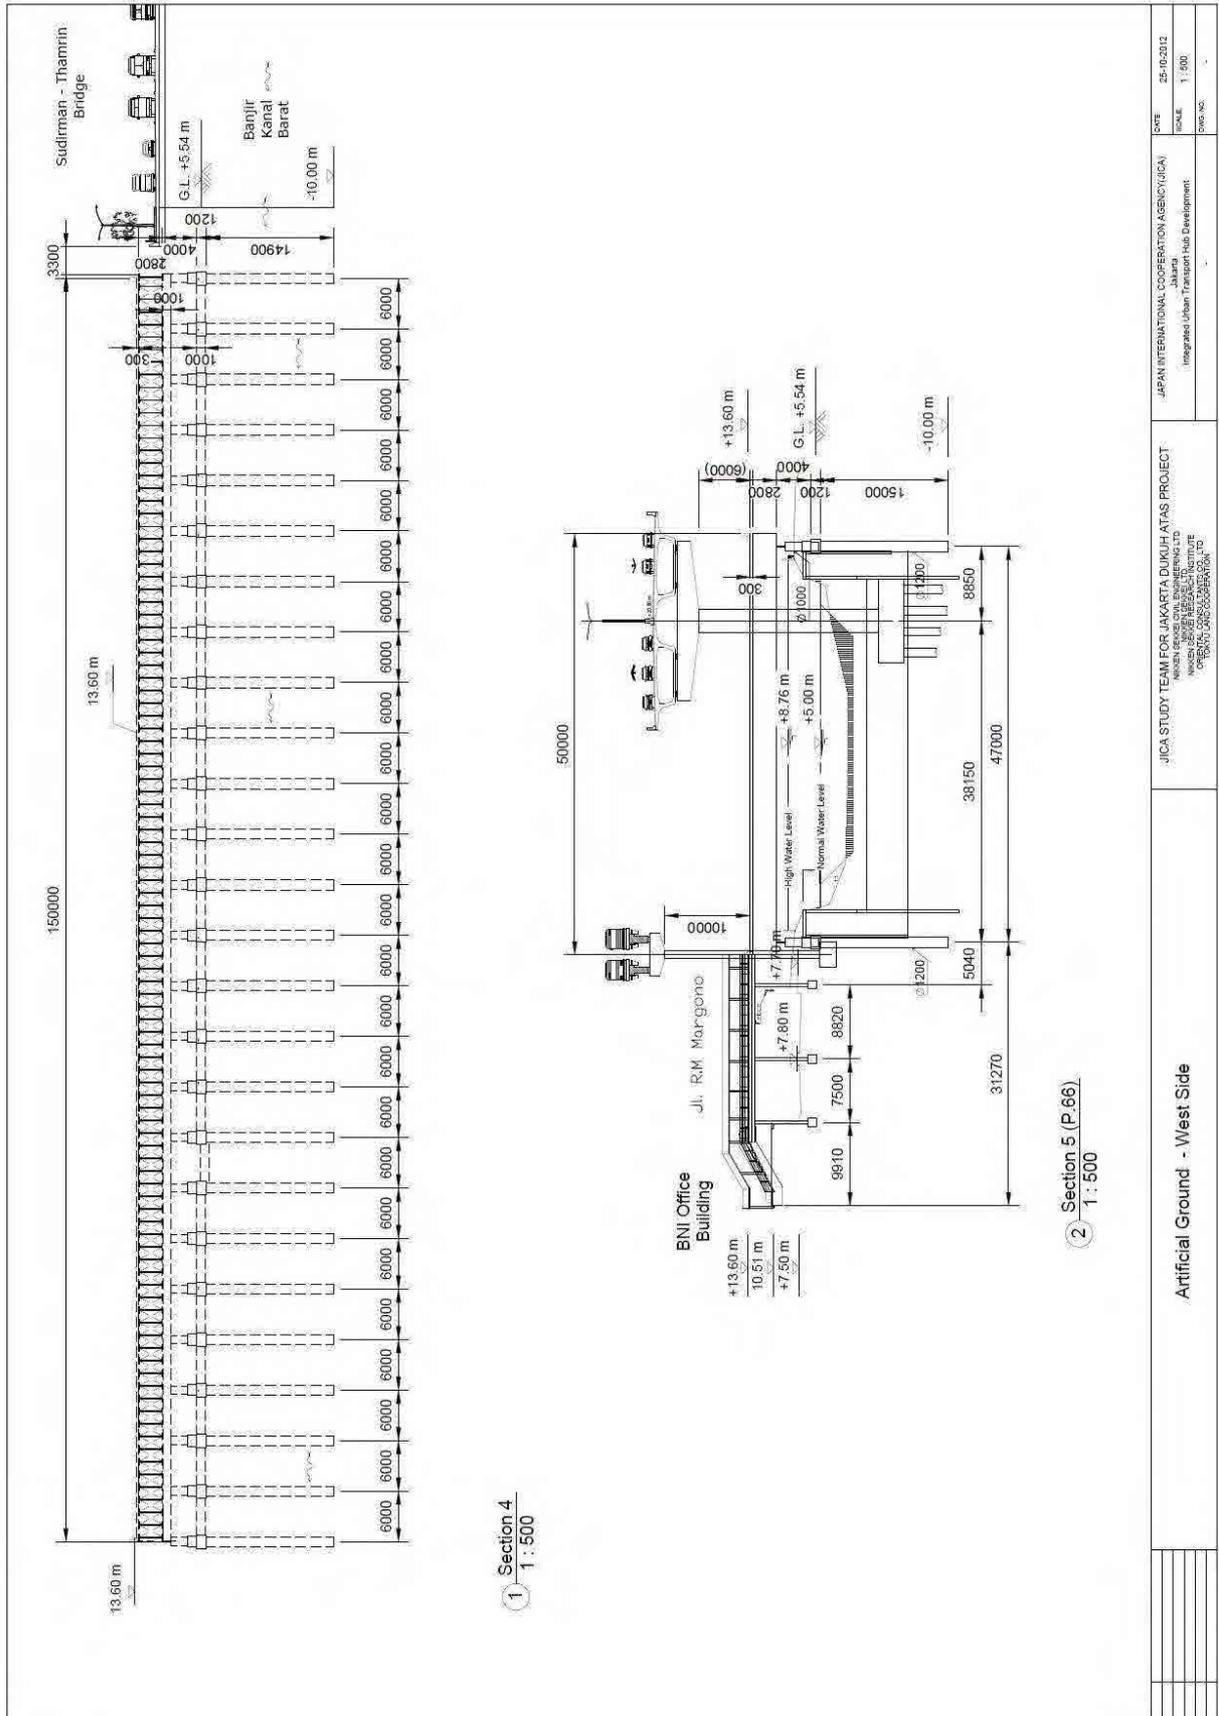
西側人工地盤断面図 (出典：調査団)
